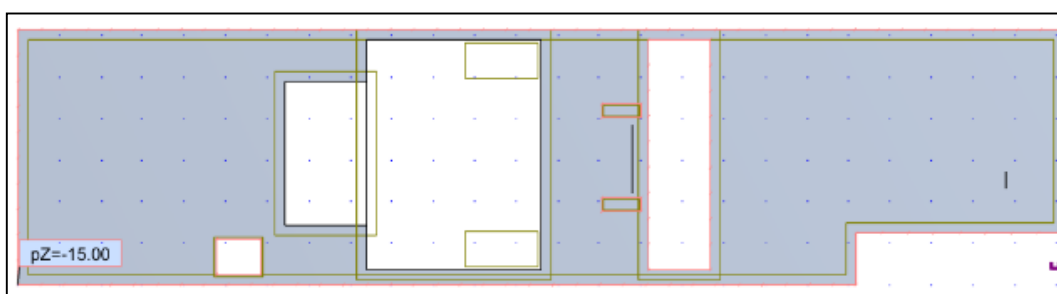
Schéma des surcharges appliquées sur le niveau de la mezzanine
